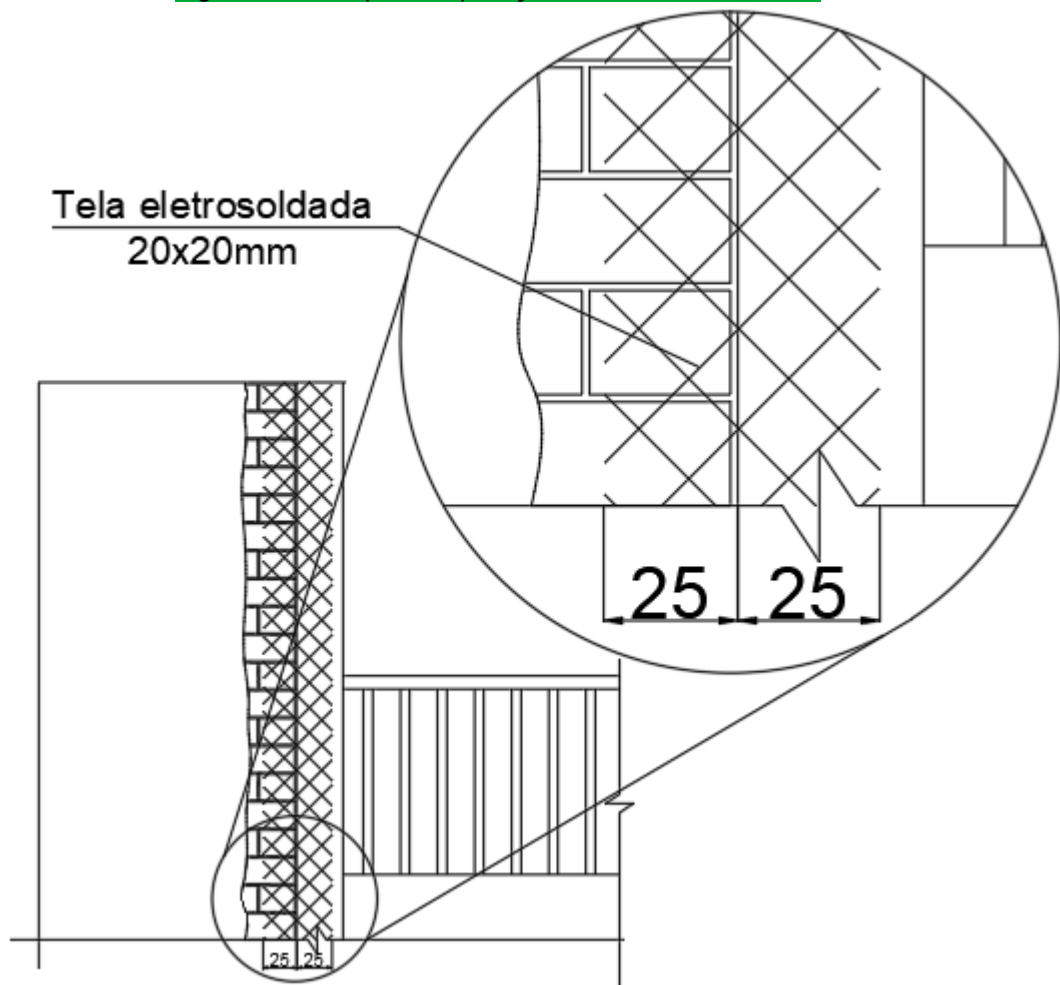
Exemplo de remoção do revestimento argamassado até a alvenaria e estrutura.
